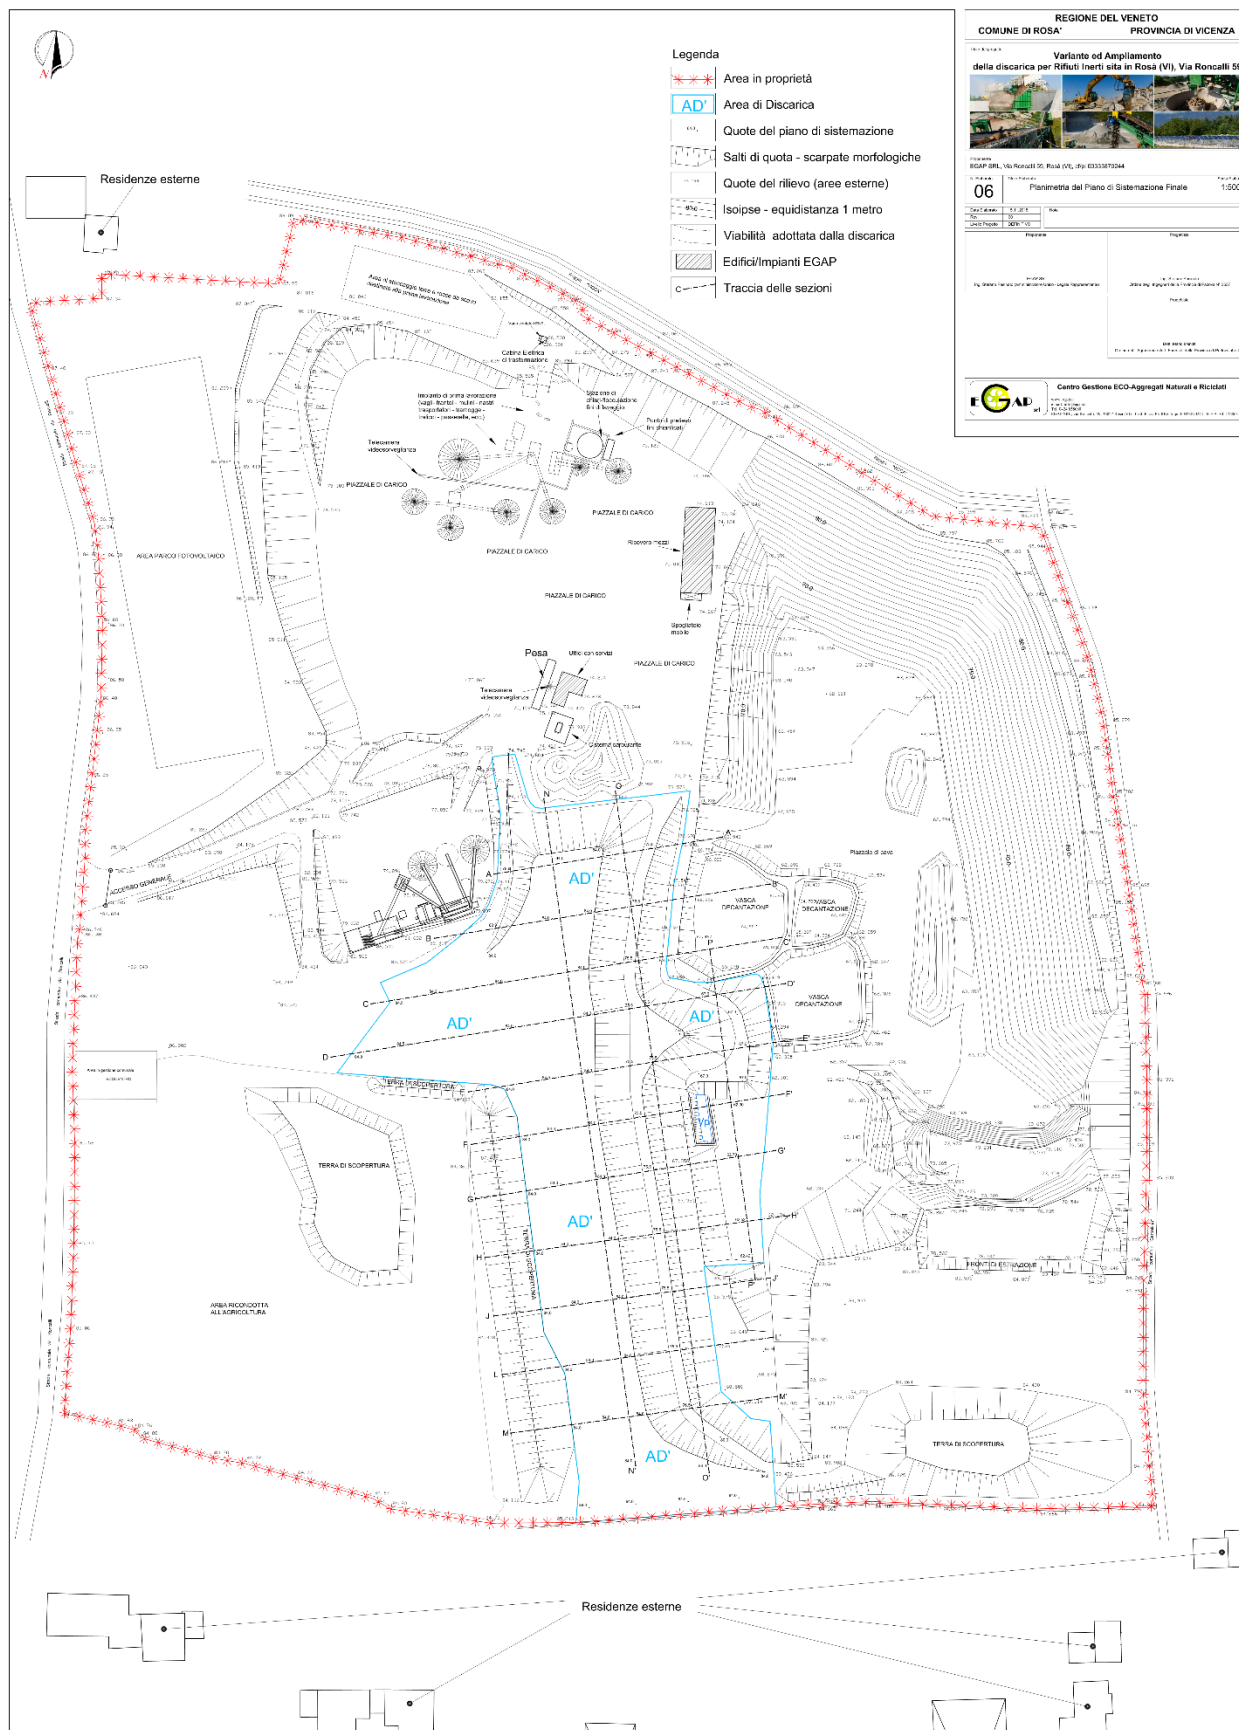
Elaborato n. 06 – PLANIMETRIA DEL PIANO DI SISTEMAZIONE FINALE
